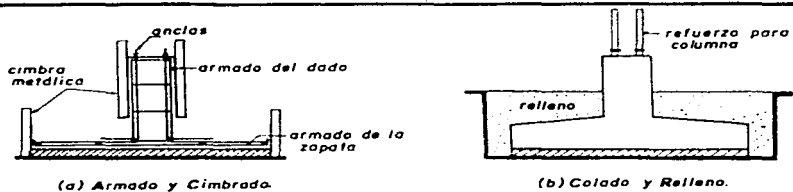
Proceso Constructivo de las Zapatas Aisladas
